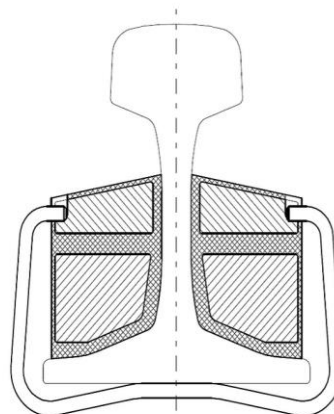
Aplicação e aspeto interno dos Rail Dumpers (<http://www.wonros.com/rail-dampers>)
